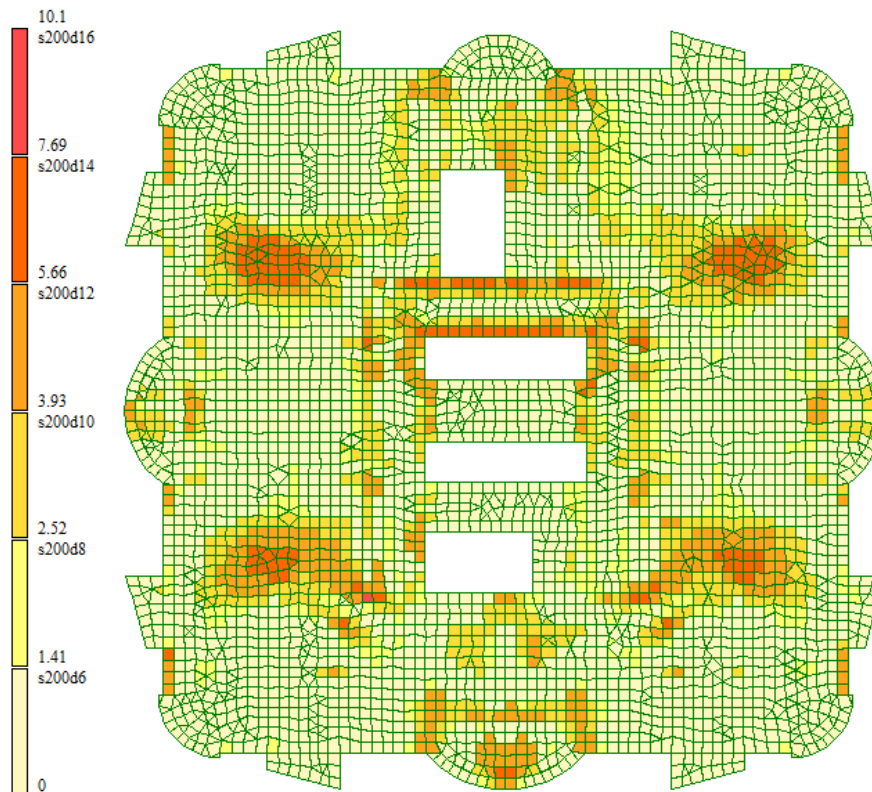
Схема армирования низа плиты перекрытия по оси OX и по оси OY
